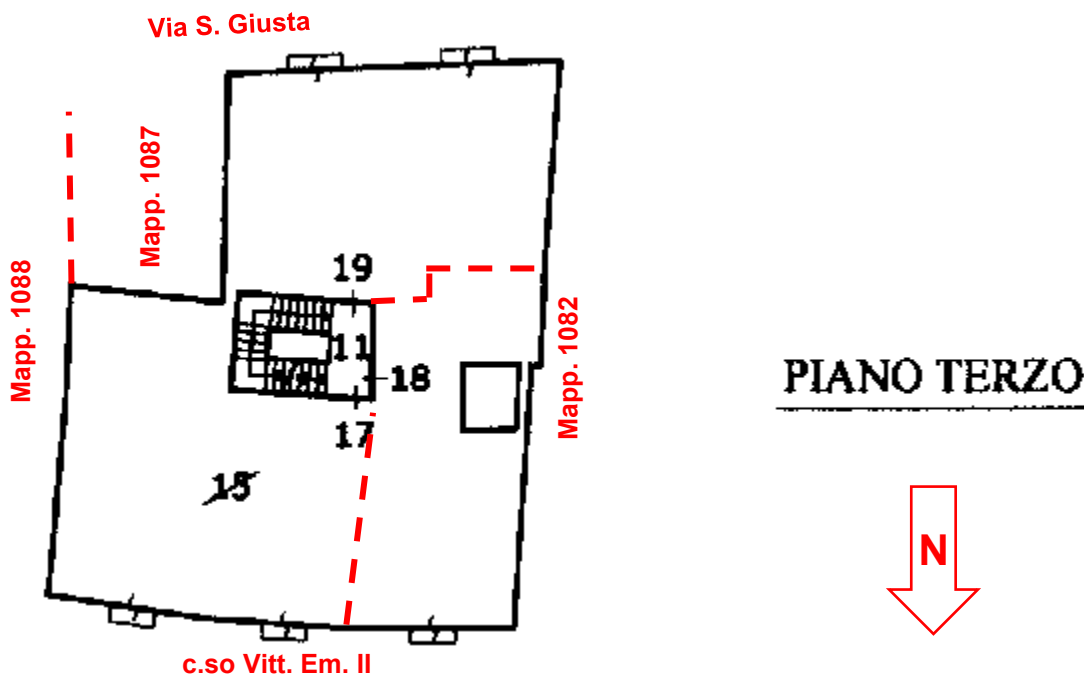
LOTTO 7. Stralcio elaborato planimetrico (fuori scala). Nord in basso
